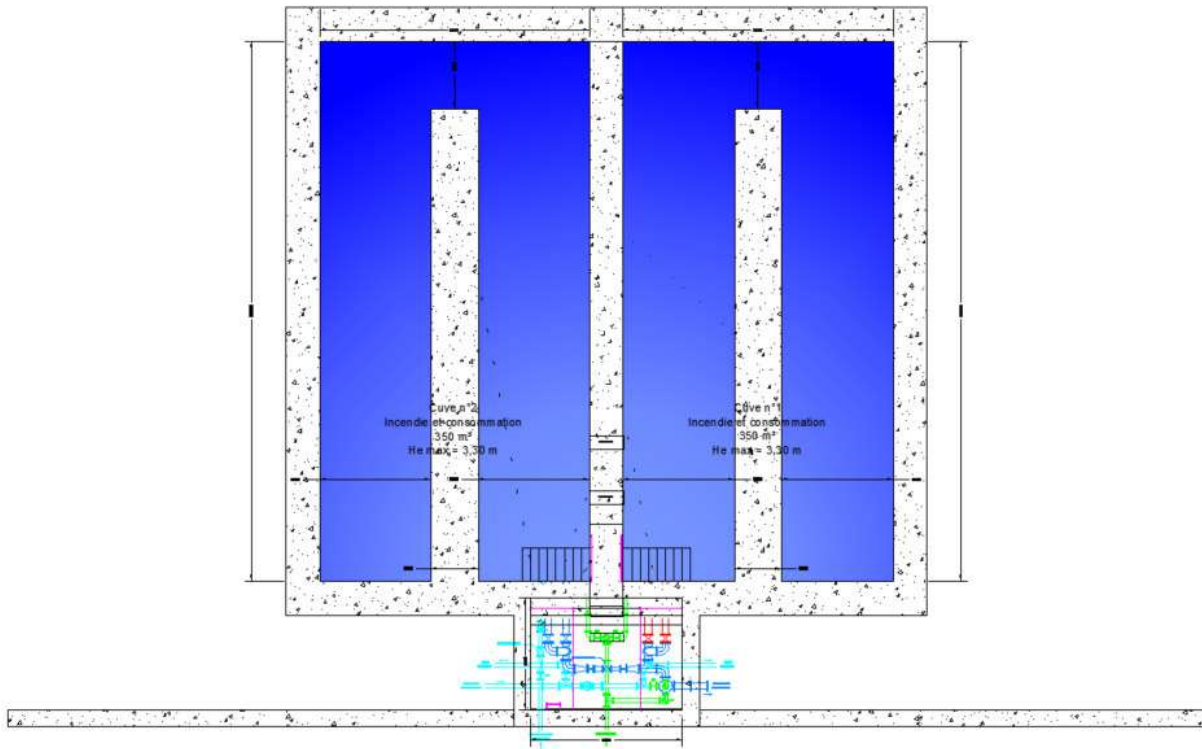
Plan du réservoir de Fellinging Zone Basse
